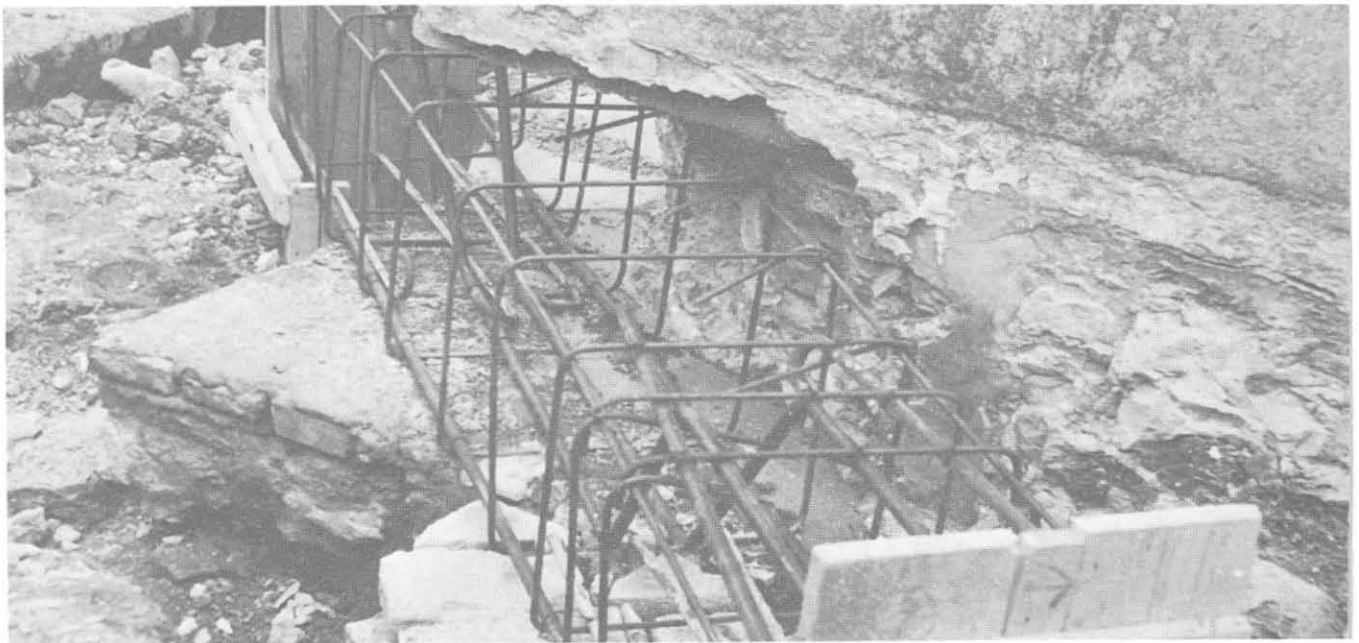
Sottofondazione di spigolo di un fabbricato.
